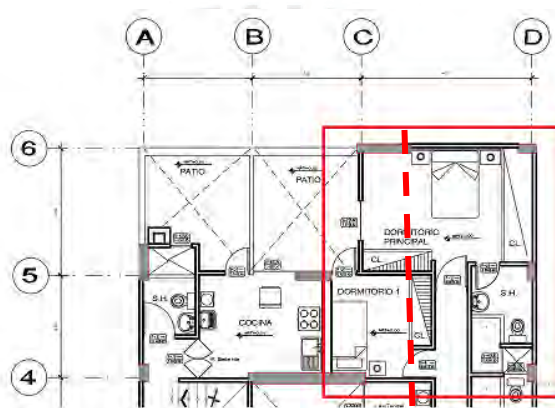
Acercamiento a los ejes 4-6 y C-D en el plano de arquitectura
